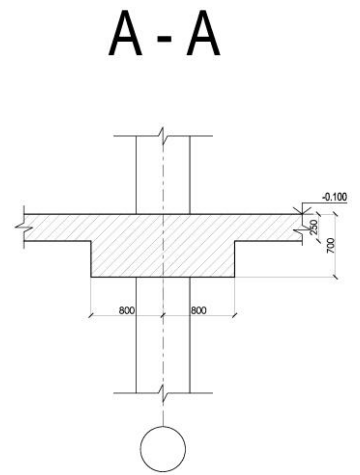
Схема капитального стыка колонны и плиты перекрытия - сечение
